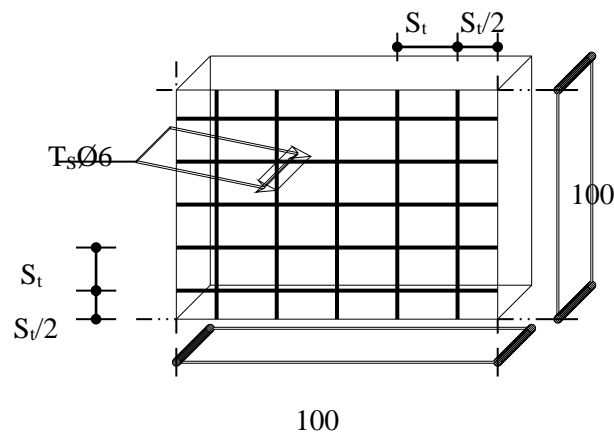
Disposition constructive des armatures de la dalle de compression.
